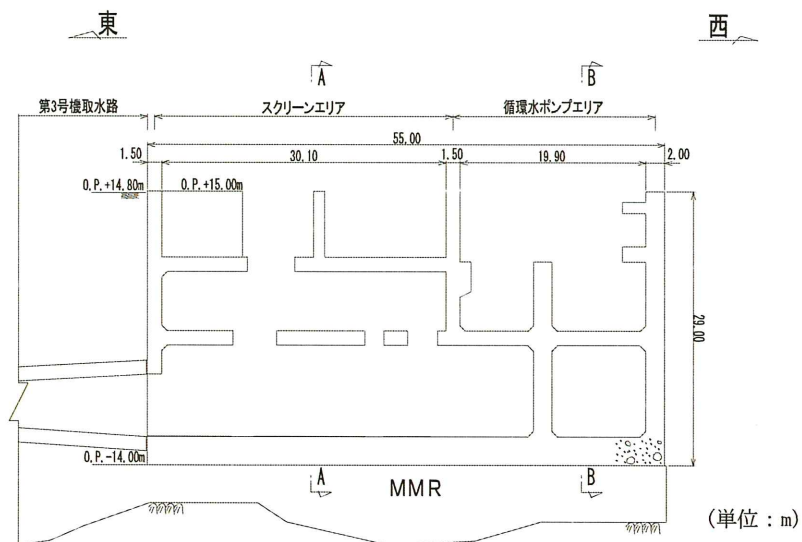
第3号機海水ポンプ室断面図 (C-C 断面)
